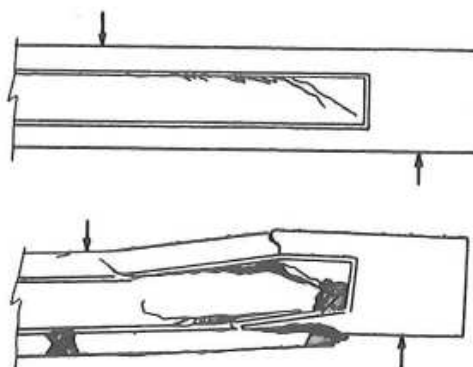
Fisuración y colapso por fisuración del alma en la unión con la cabeza de compresión (Sozen)
